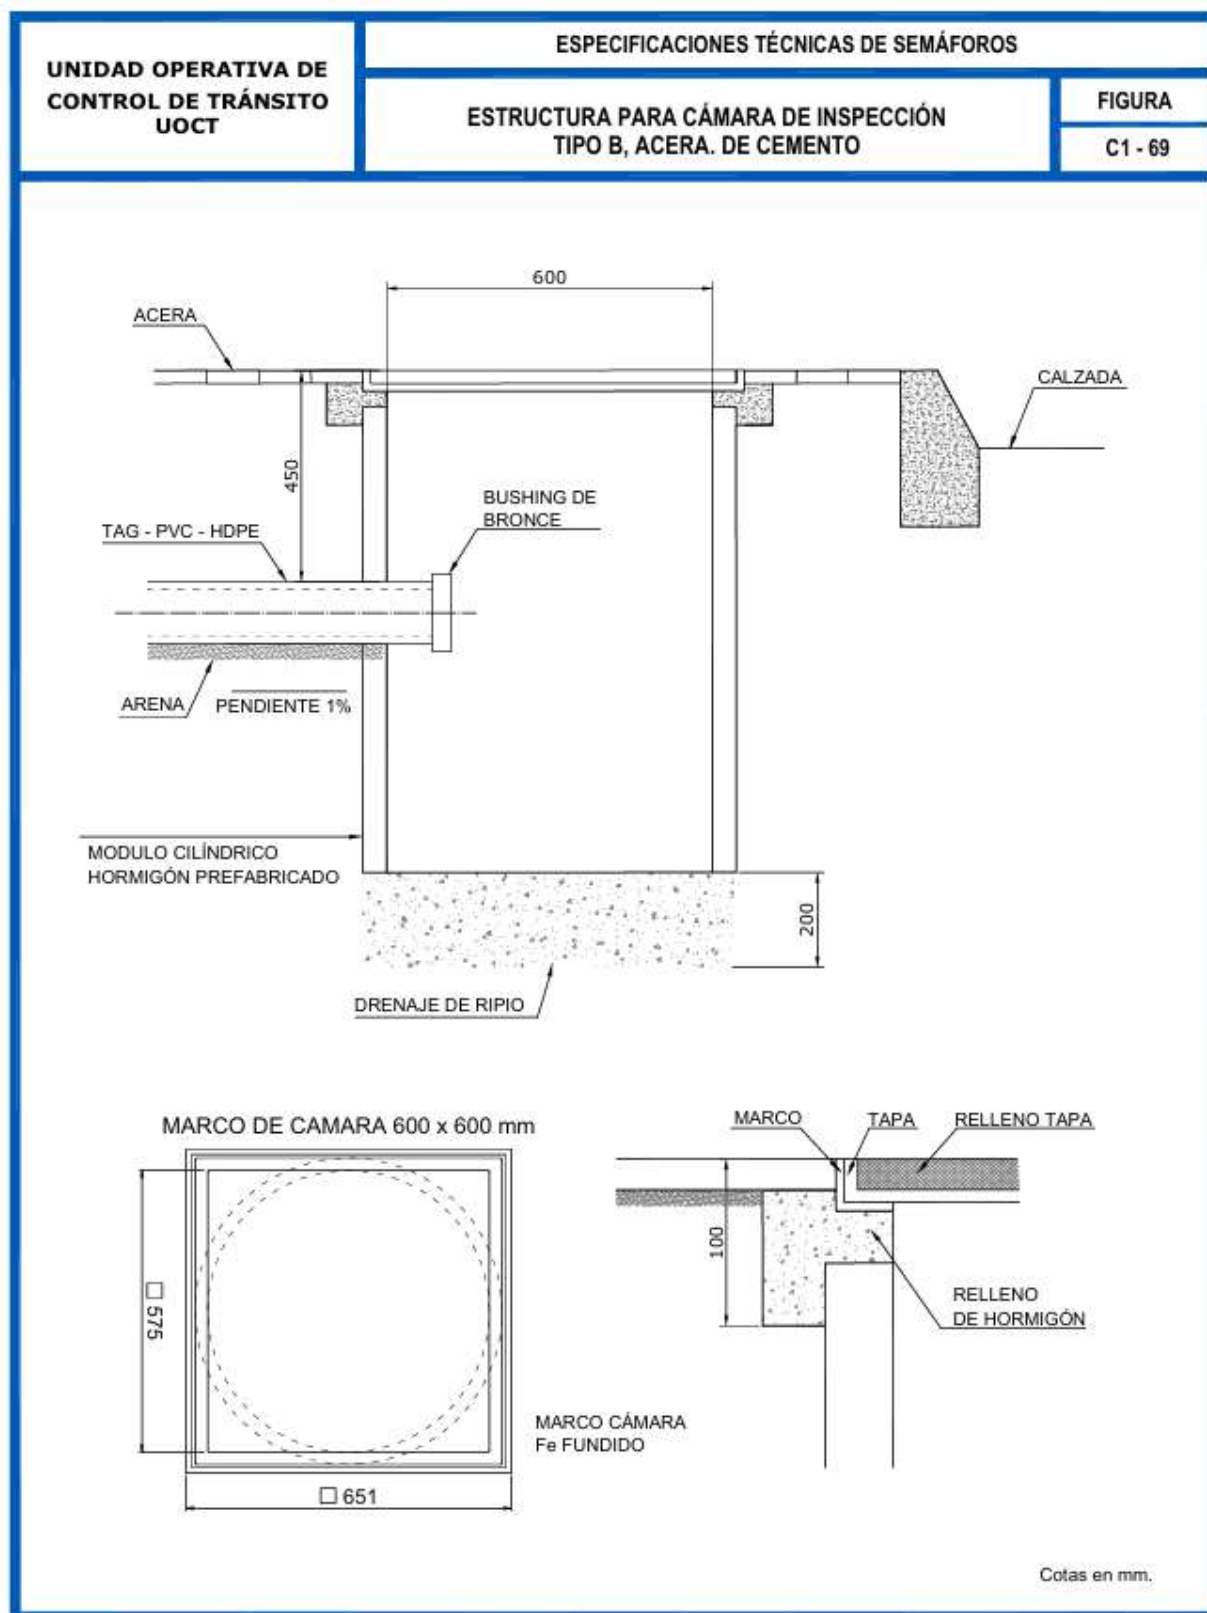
69 Estructura para Cámara de Inspección para Acera Tipo B, de Cemento
